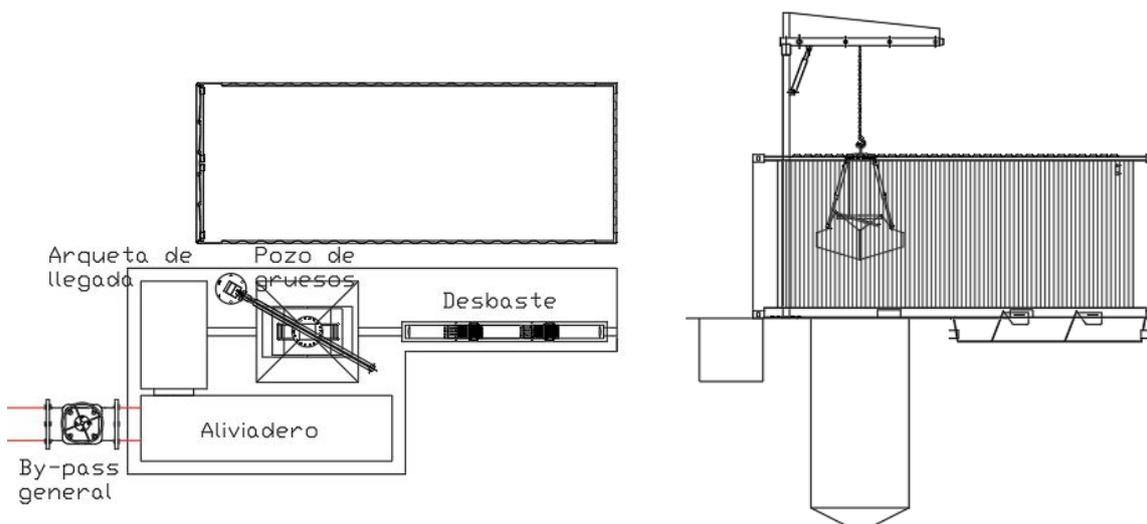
Detalle pretratamiento. Fuente: Edición propia
